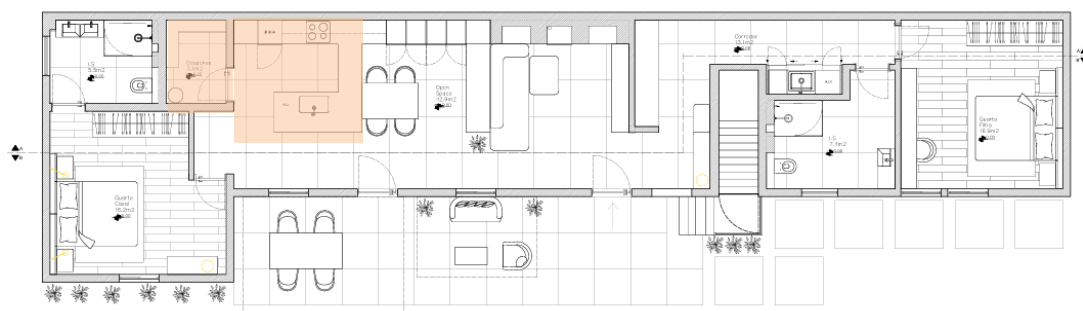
Planta de apresentação zona da cozinha Fonte: Autor
